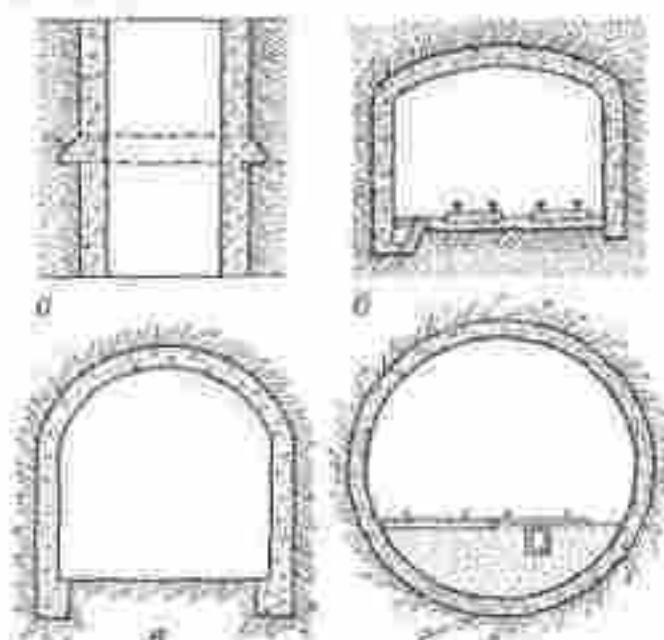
Крепи капитальных выработок: а — бетонная круглая крепь вертикального ствола (продольный разрез); б и в — бетонные монолитные сводчатые крепи горизонтальных выработок; г — бетонная монолитная круглая крепь горизонтальной выработки.
